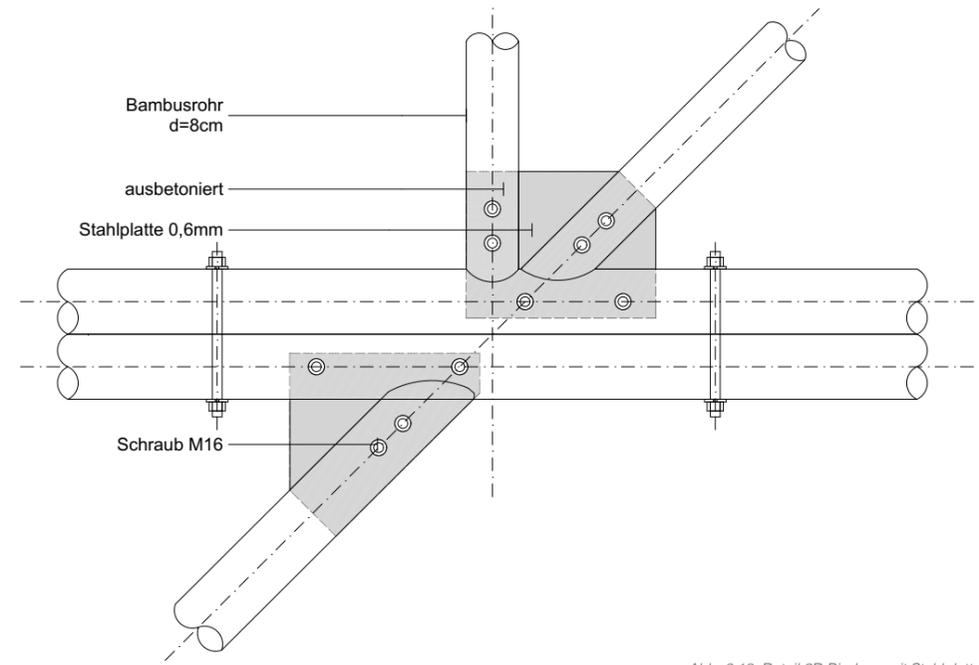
Detail 2D Bindung mit Stahlplatte
